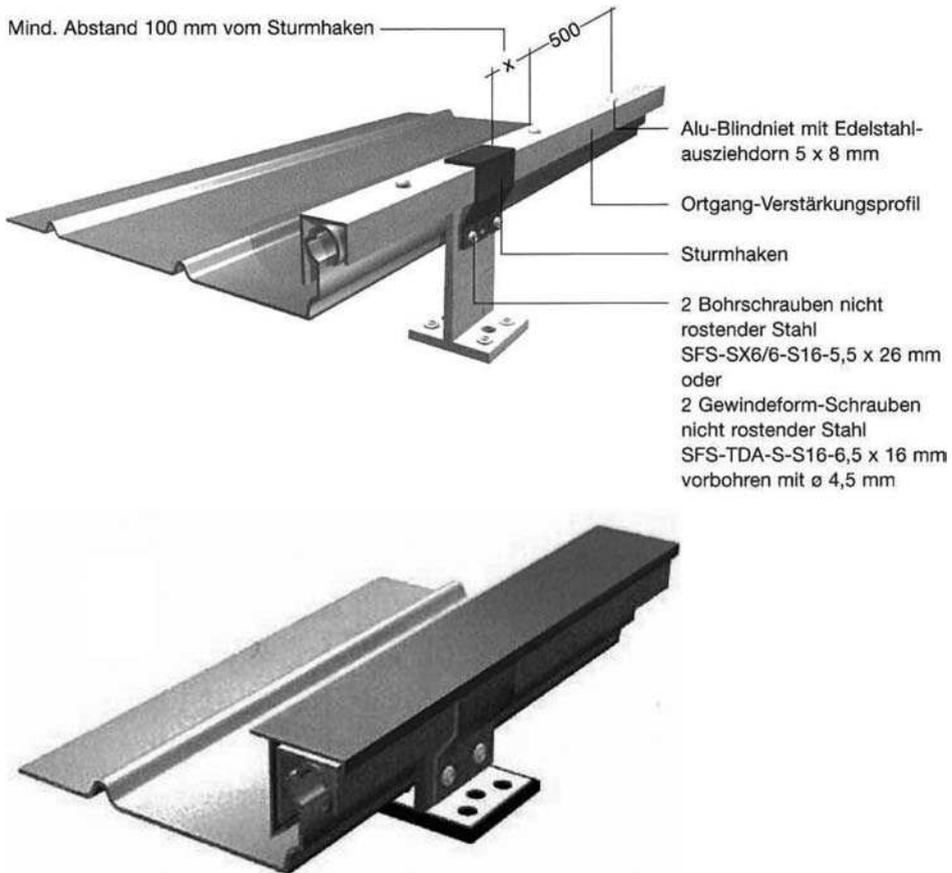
Ortgangausbildung bei Stehfalzprofildeckung
